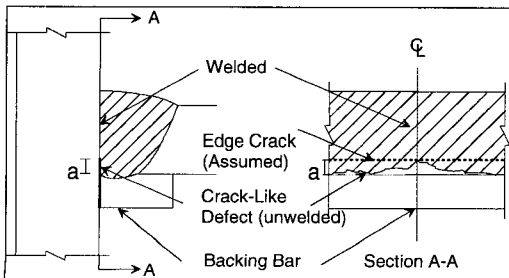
기둥과 용접의 경계면의 crack-like defects와 edge 균열로 이상화된 대표 균열
